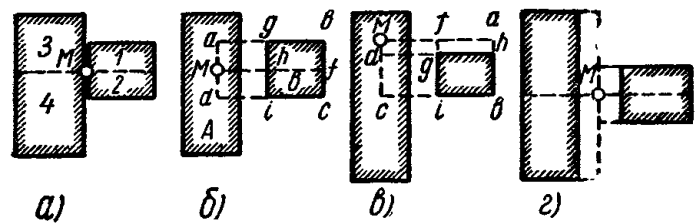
Схема разбивки фундамента на прямоугольники при определении осадок по методу угловых точек с учетом влияния соседних фундаментов
